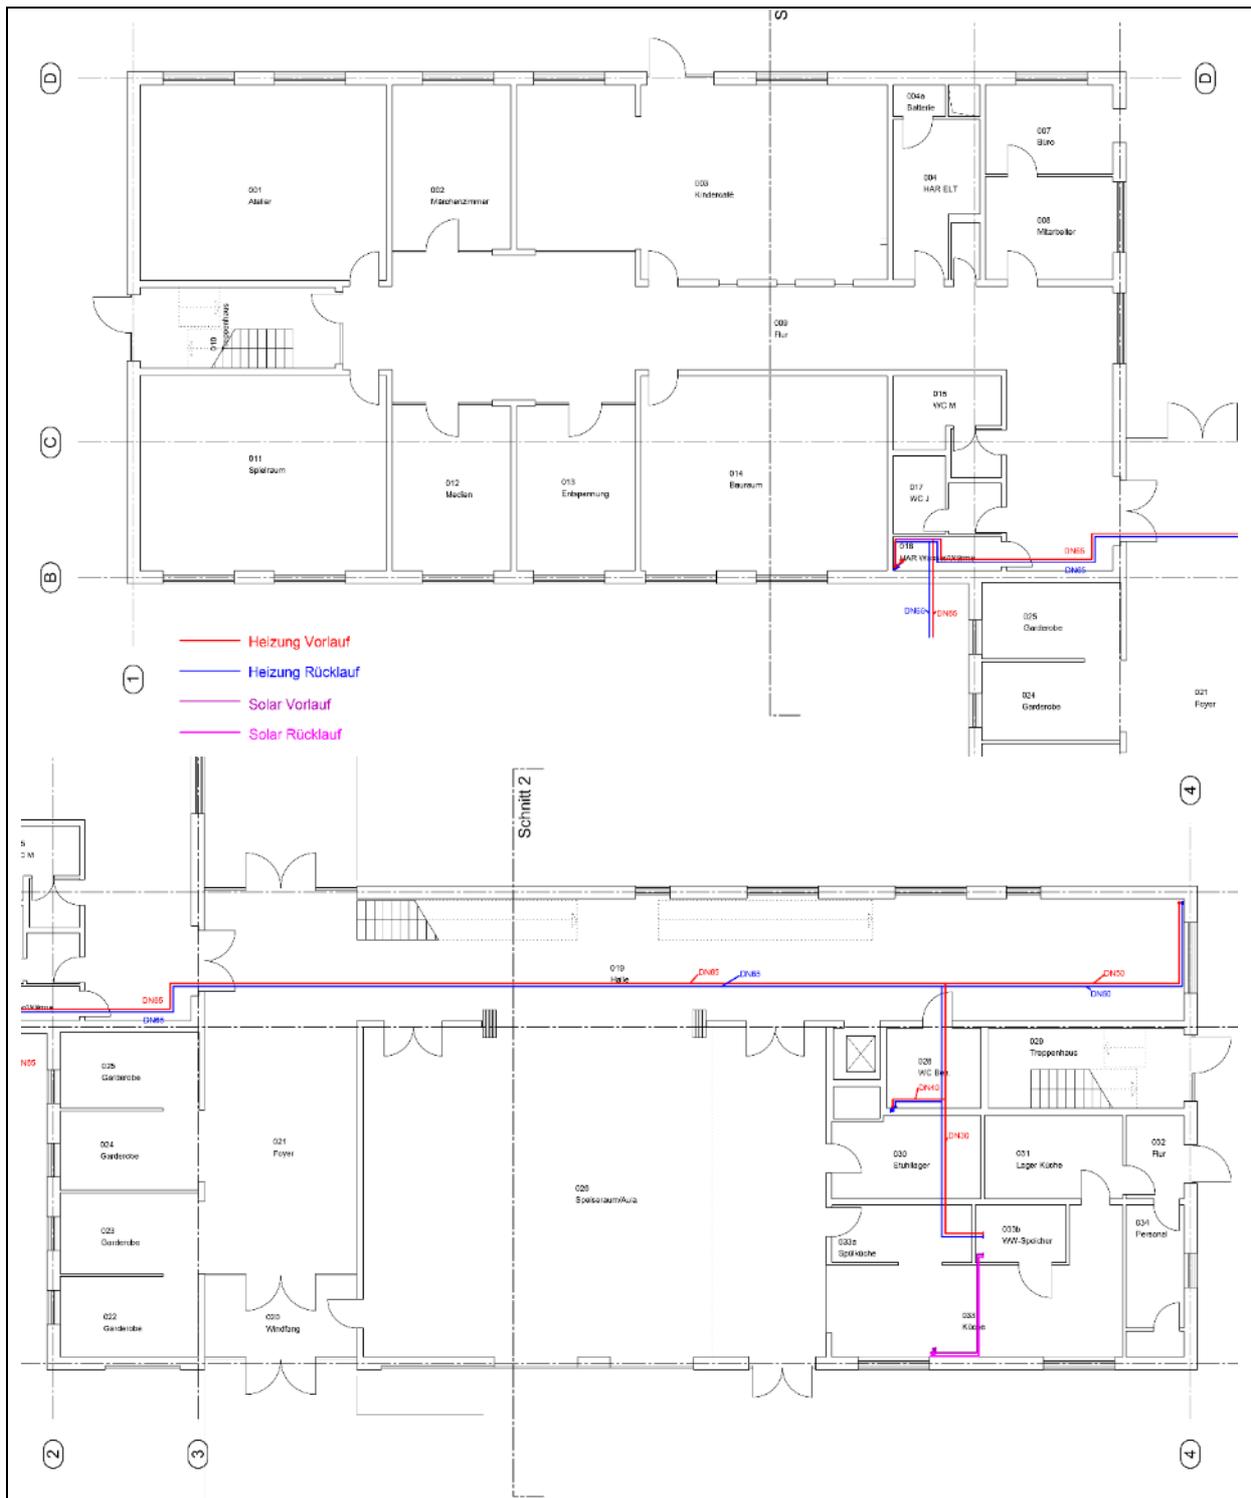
Grundriss Heizung – Erdgeschoss – BTA (unten) und BTB (oben) [3]
